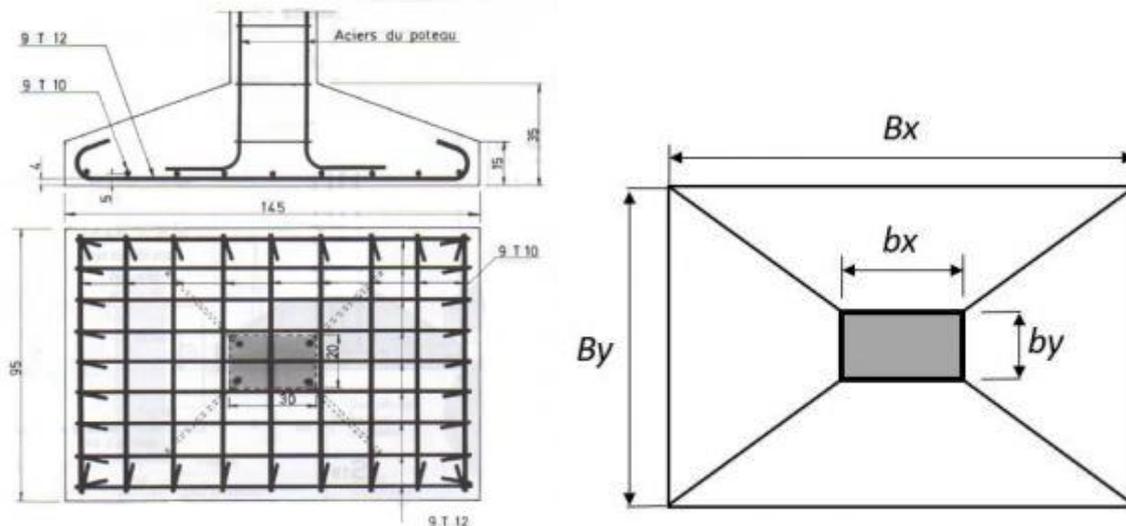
Exemple de ferrailage fondation type semelle isolée.
